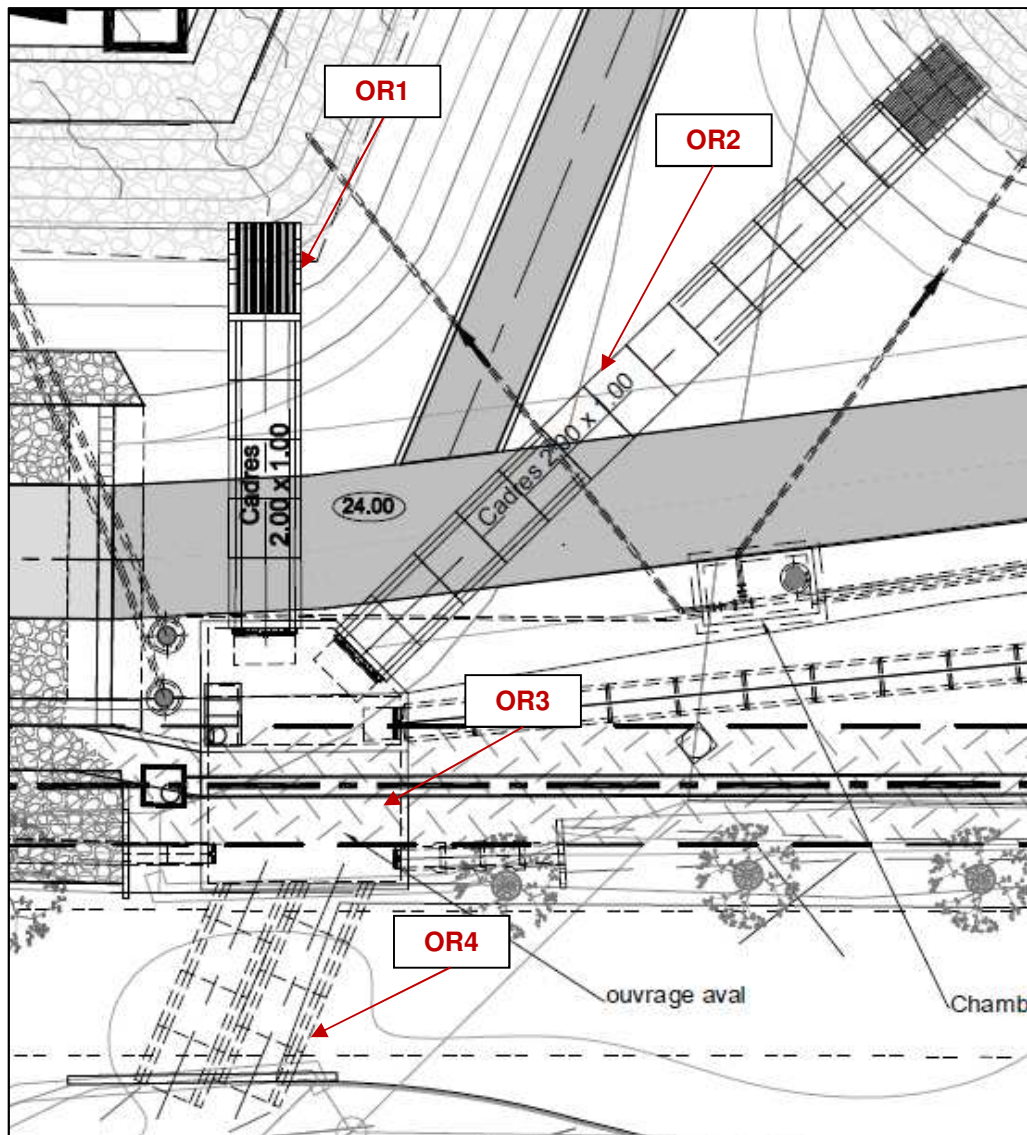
Vue en plan de l'ouvrage de restitution aval
